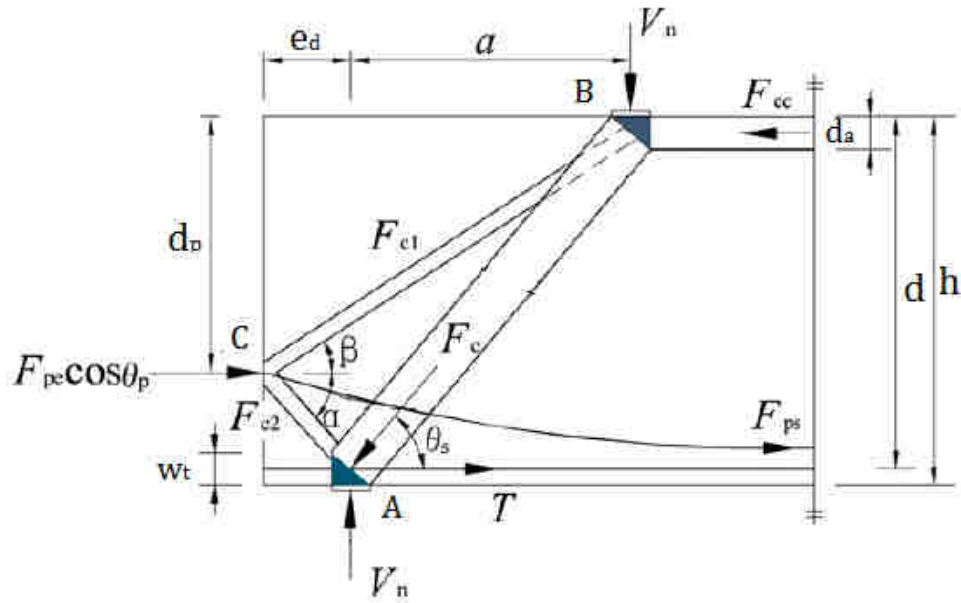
Modelo de bielas e tirantes para vigas-paredes protendidas (adaptado de WANG e MENG, 2008).
